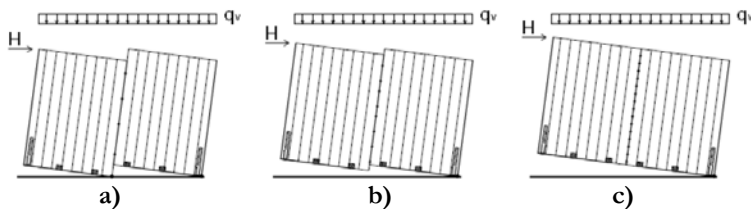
Pannelli X-lam accoppiati: a) coupled wall, b) single-coupled wall, c) single wall
